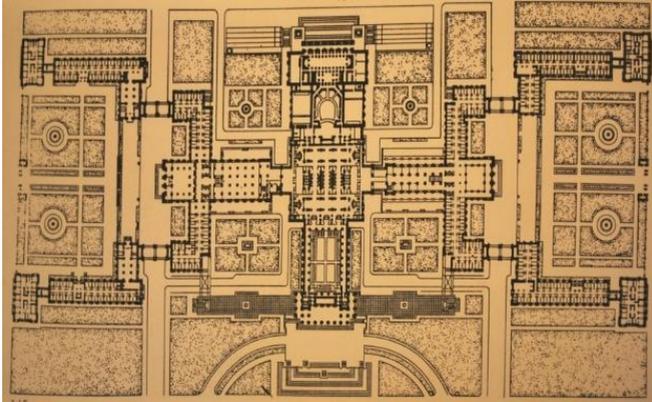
Planta Baixa do Teatro do Exército Vermelho
